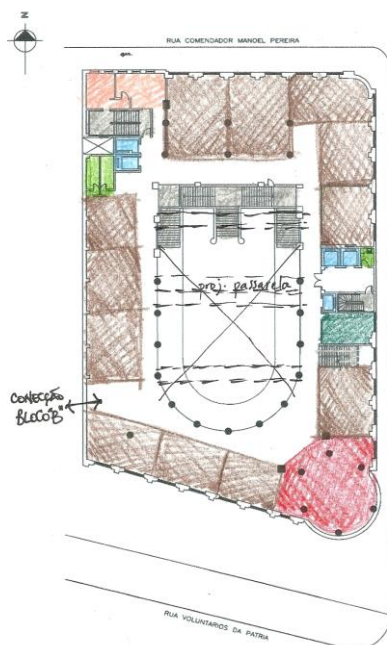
Planta Baixa Tipo - Mapa de Manchas com zonamento da proposta de intervenção.
